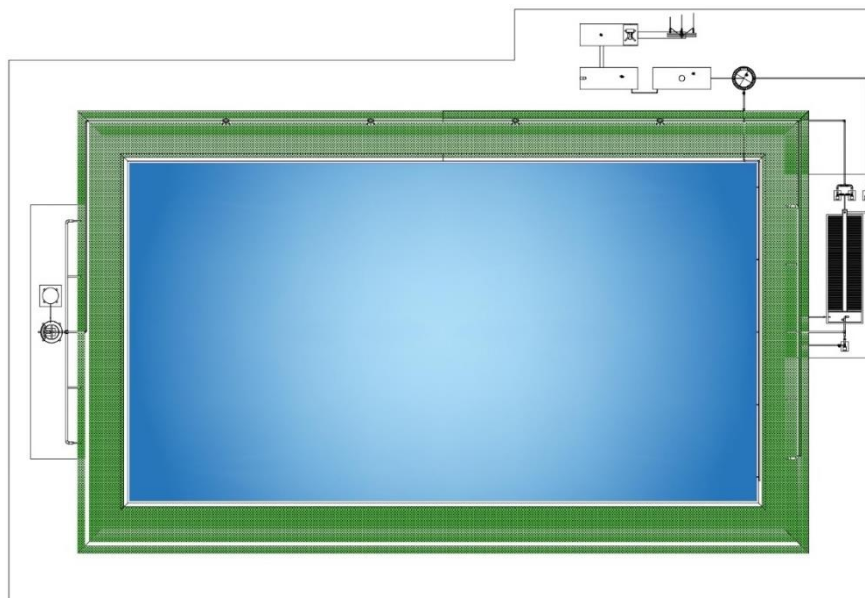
Desenho esquemático da lagoa coberta, corte longitudinal
